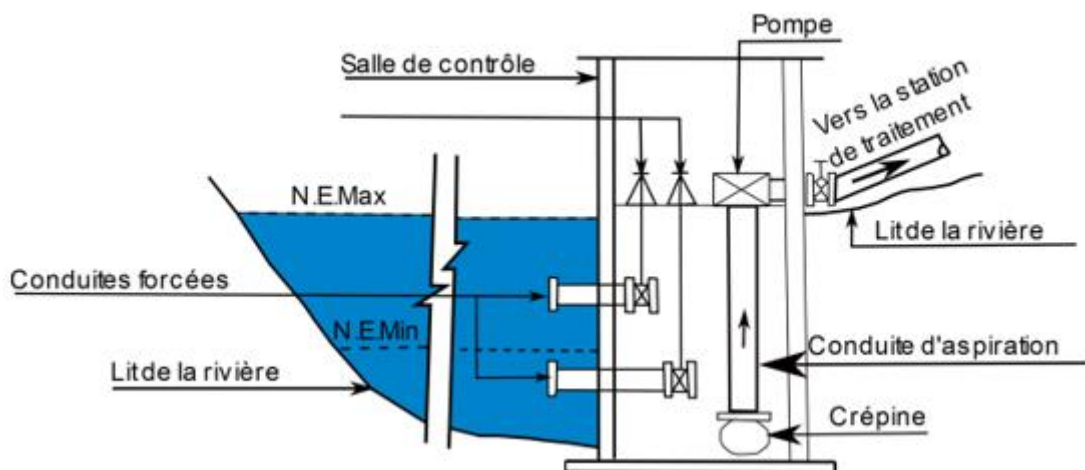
Schéma d'une prise d'eau simple sur la berge d'une rivière (Boulmaiz, 2019)
